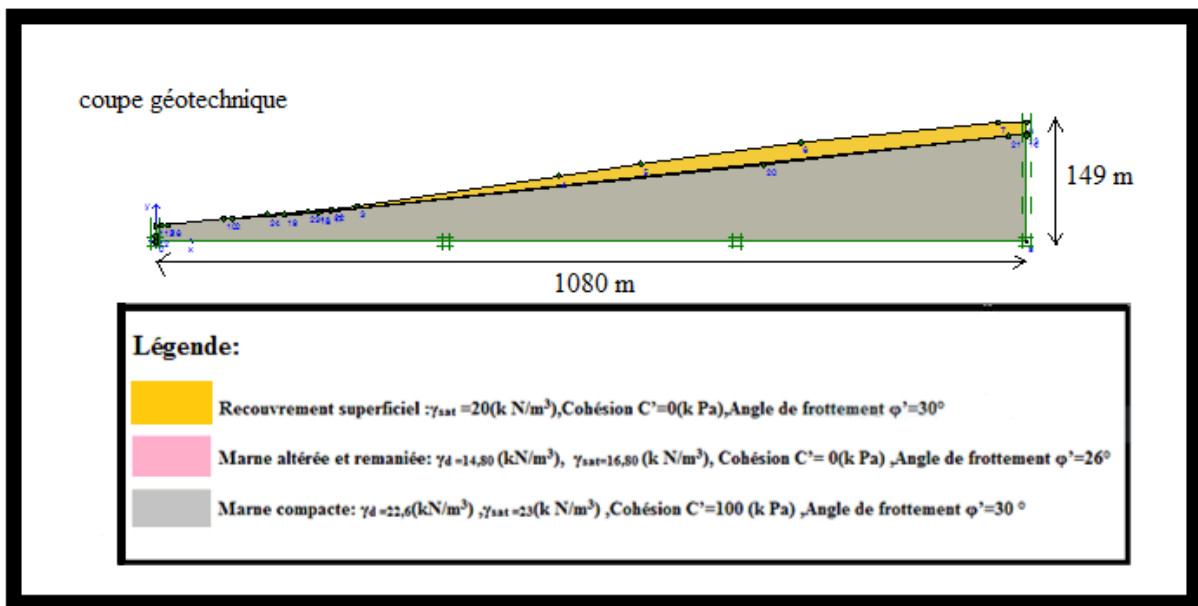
la coupe géotechnique adoptée pour le site d'étude. (Réalisée sur Autocad et appelée sur plaxis).
